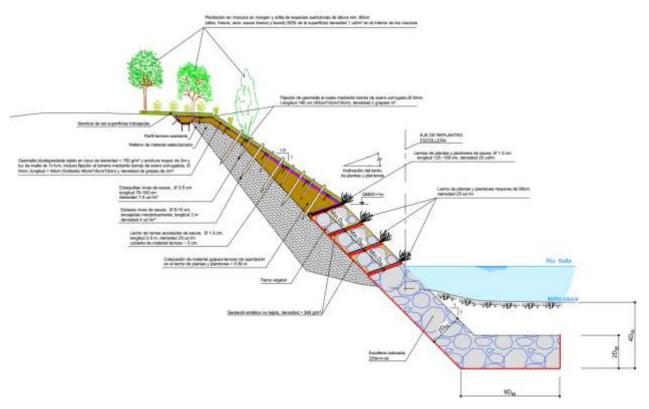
Sección tipo estabilización mixta (vegetal / escollera)
